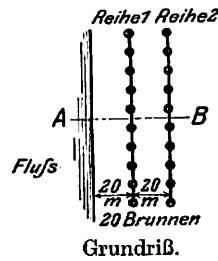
Zweireihige Anlage neben offenem Gewässer (nach Kyrieleis).
